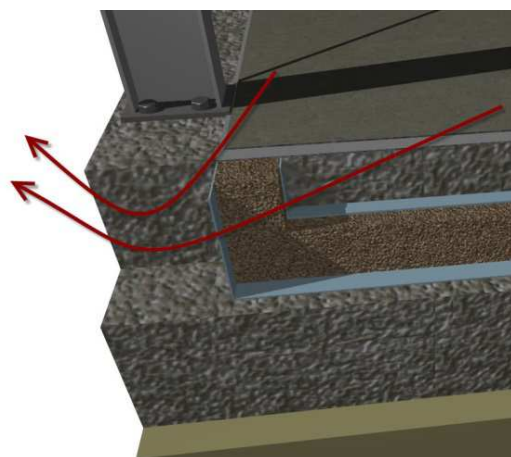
3D shematski prikaz fasadnega ovoja s fasadnimi paneli, brez izolacije med nosilci
